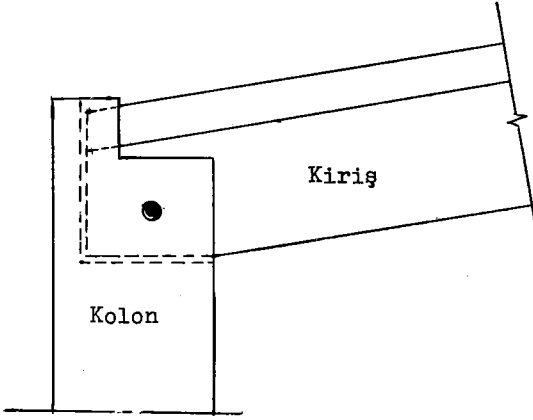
Mafsallı Zayıf Bir Kolon-Kiriş Bağlantısı
